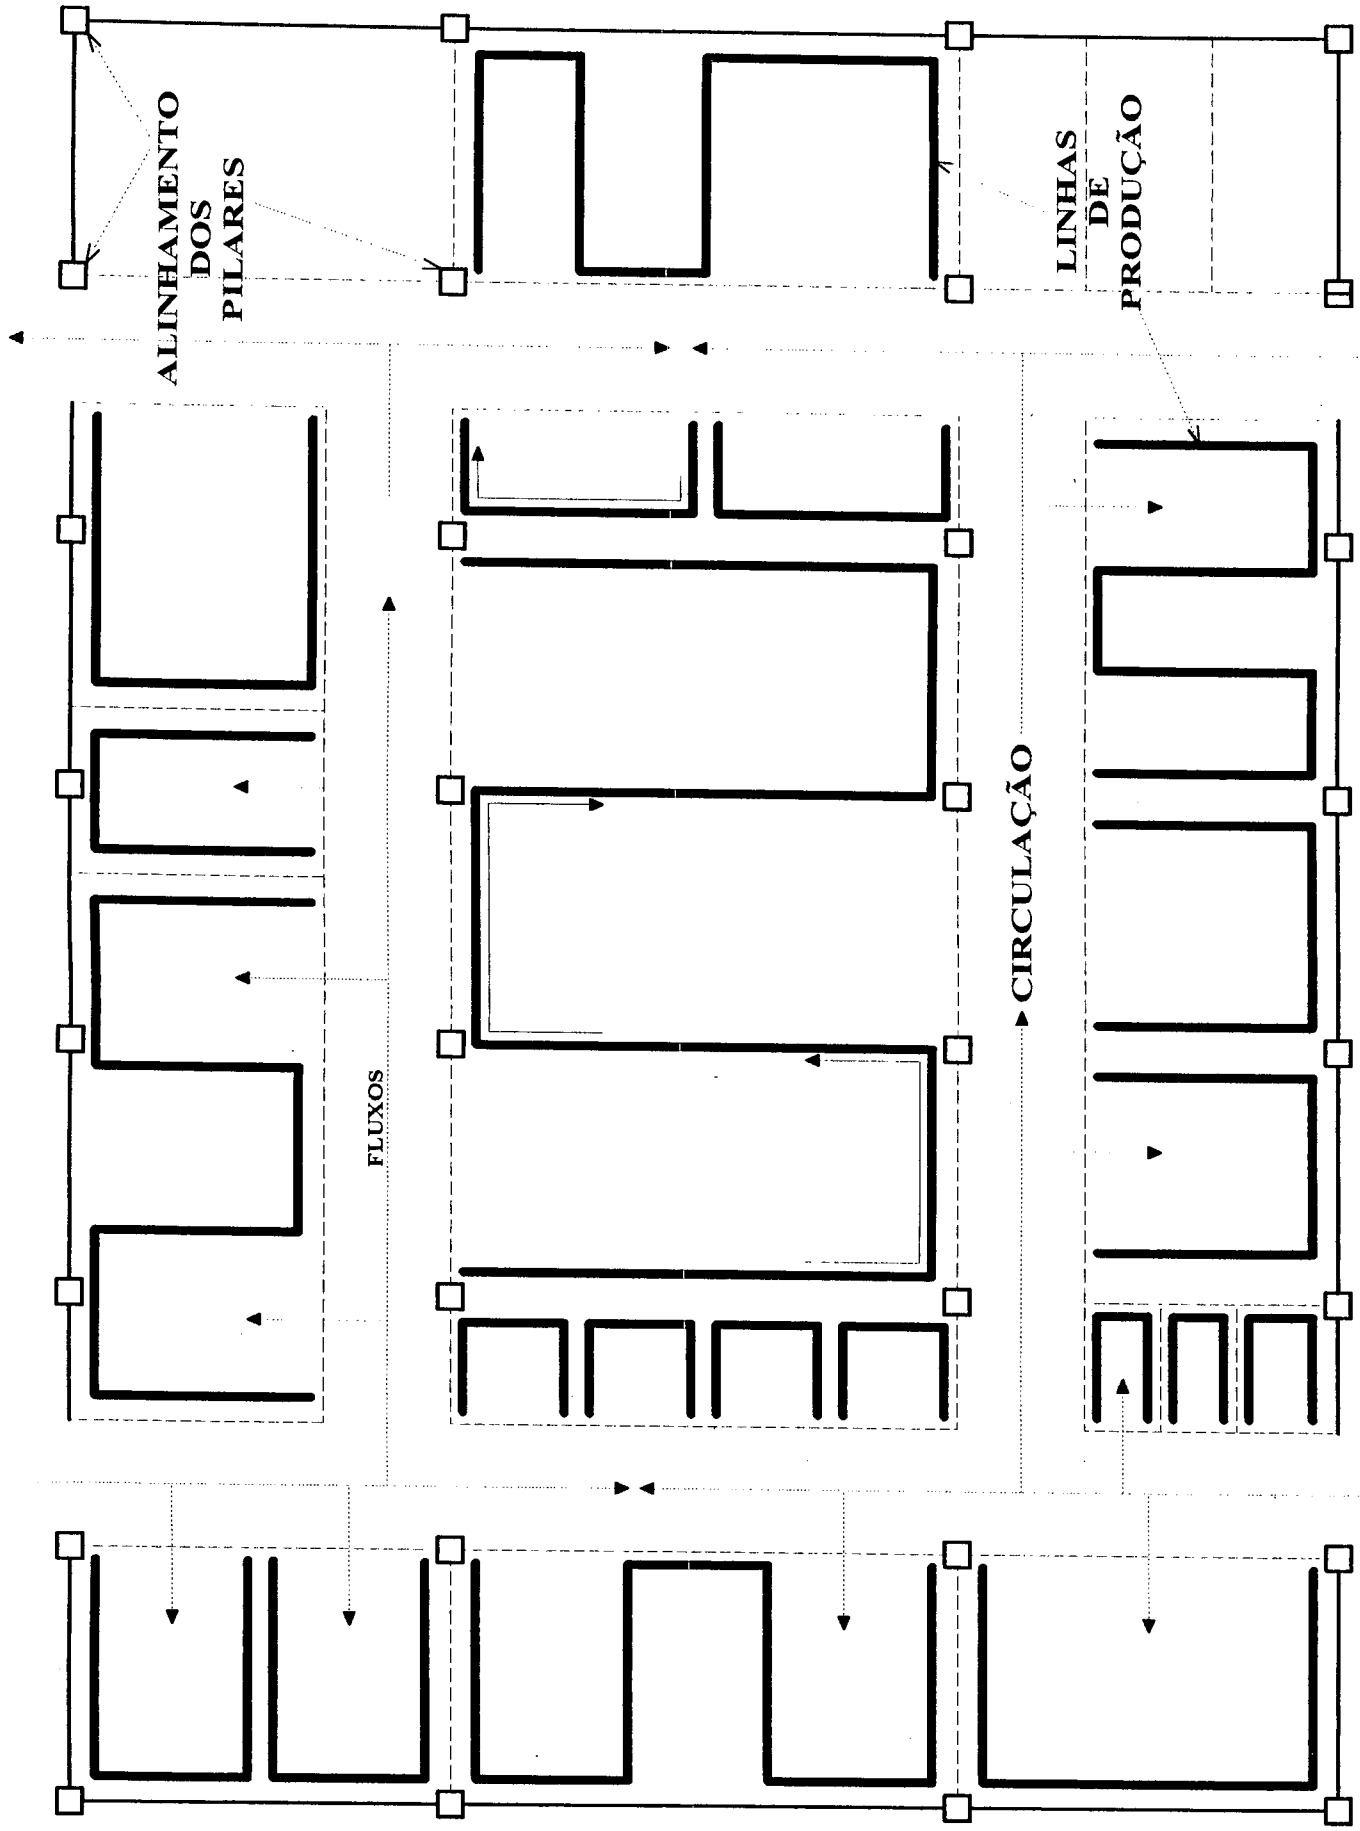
Conciliação Modularizada entre Arranjo Industrial e Pilares Estruturais
